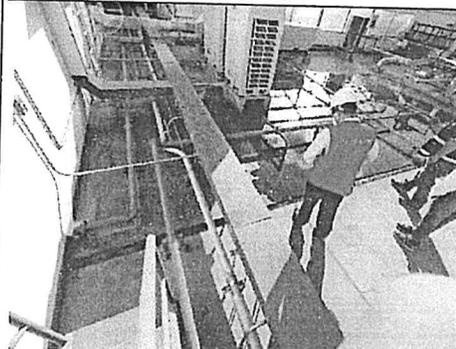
Inspección al sistema de drenaje pluvial del bloque A1 y A2.
